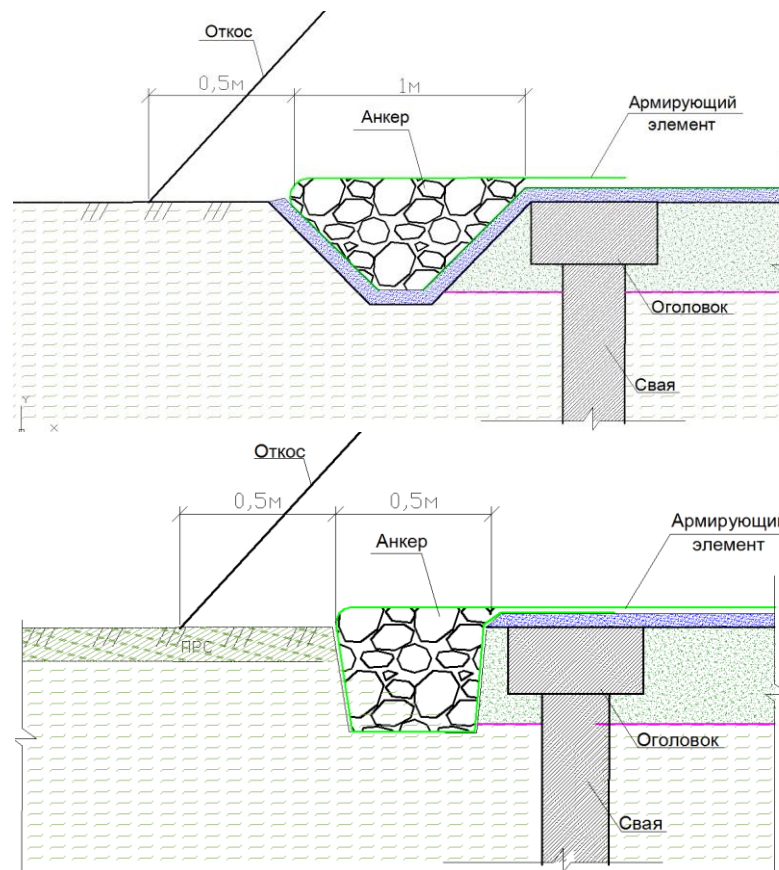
Схемы конструктивных решений по анкерровке армирующего элемента
